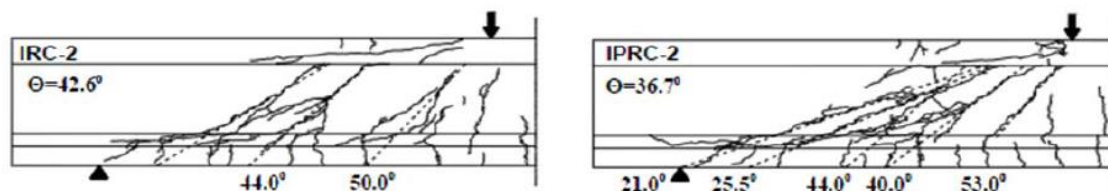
Patrones de fisuración diagonal en hormigón armado (RC)(izquierda) y hormigón parcialmente pretensado (PRC) (derecha). De Silva [11]
